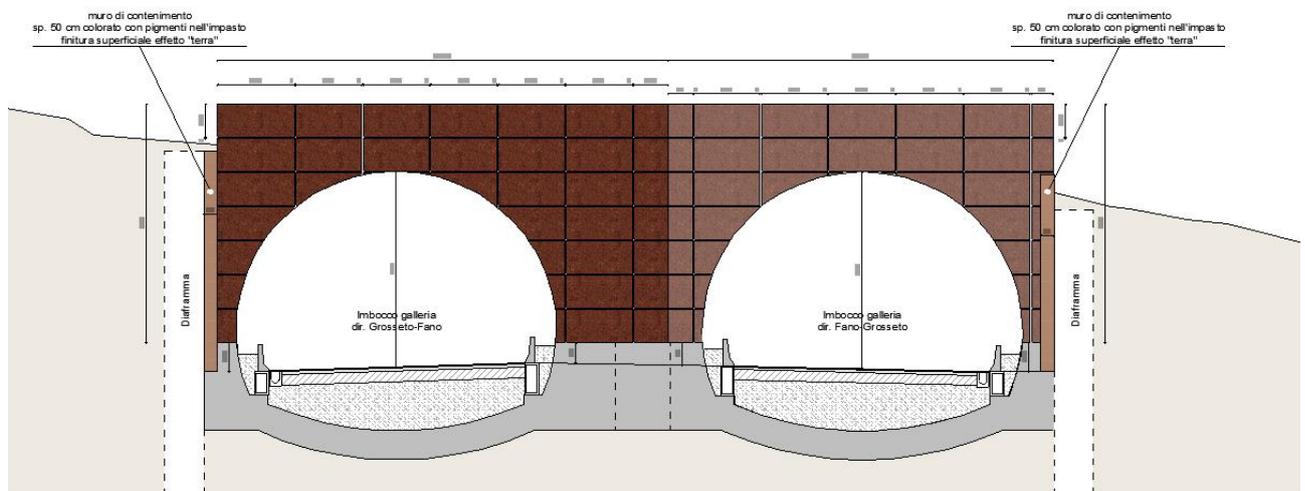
Prospetto imbocco galleria Bucciano dir. Fano
